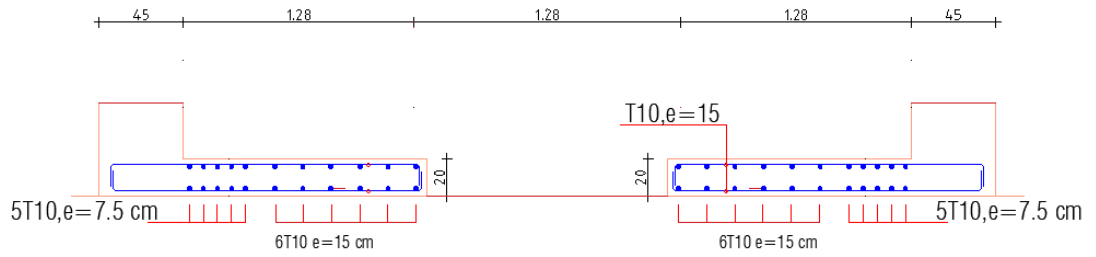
Ferrailage du voile Vy2 Zone 2
